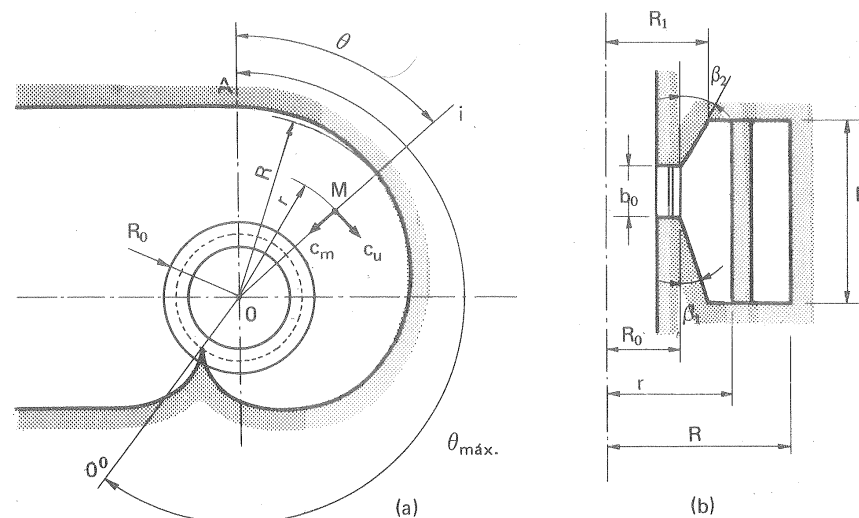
Cámara espiral de sección rectangular trapezoidal
